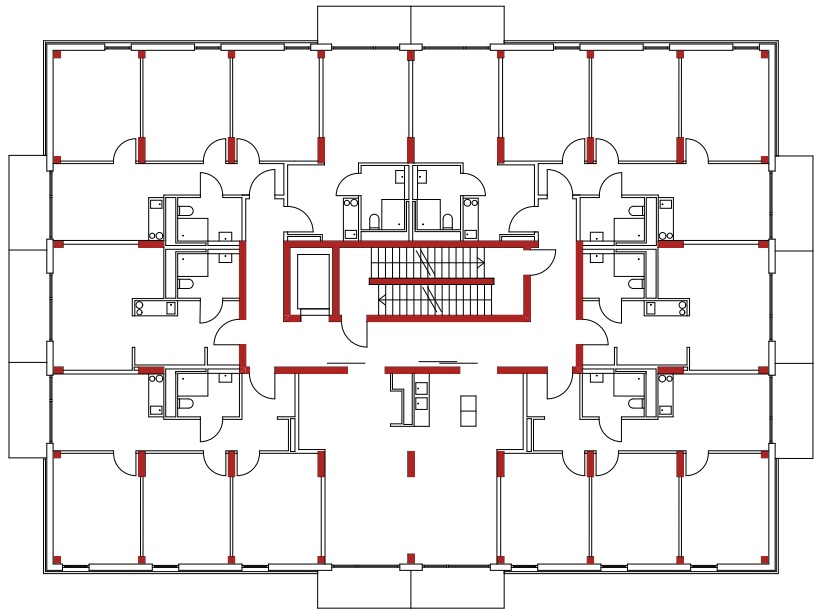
Berlin-Marzahn: Für Umnutzungen weitgehend flexible Grundrisstruktur mit farblicher Hervorhebung der nicht veränderlichen Tragstruktur. Der Ausbau kann bis auf den Treppenhaukern und einzelne Stützen rückgebaut werden. Selbst die Fassade lässt sich gegebenenfalls austauschen. [© BF Vario]
